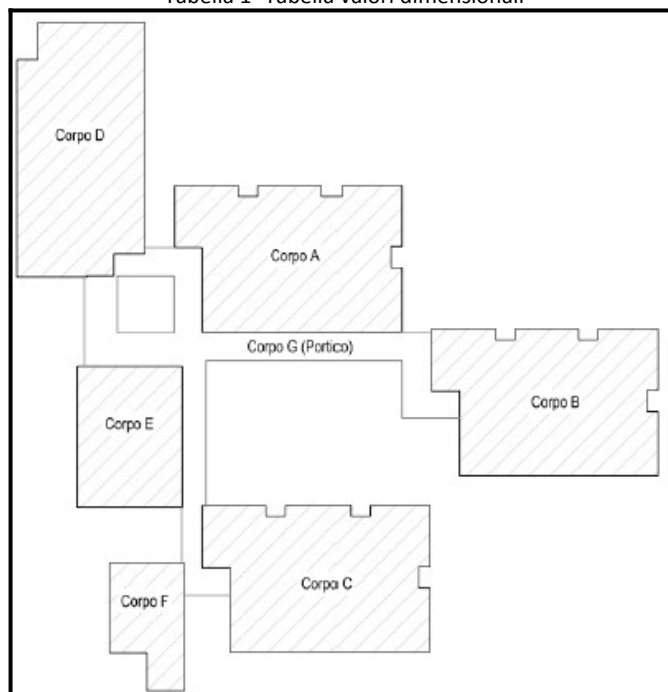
schema planimetrico con identificazione dei corpi strutturali
